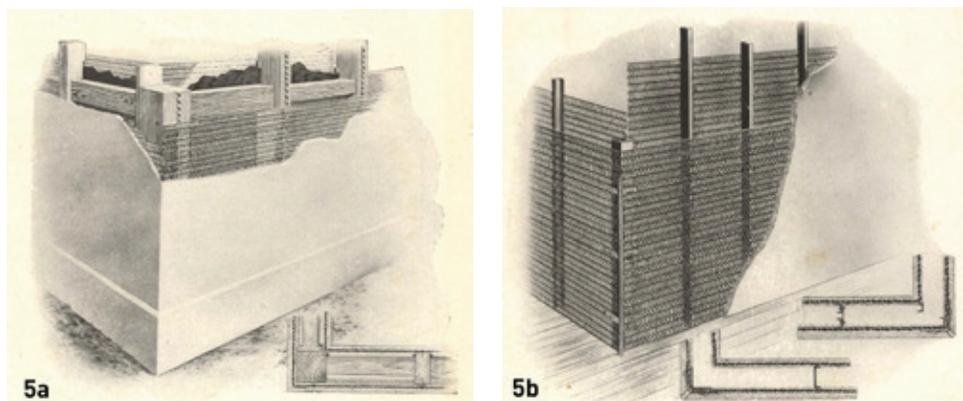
Detalles del empleo de la malla Herringbone en tabiques huecos (a dos caras) sobre estructuras de madera (5a) y metálicas (5b). Fuente: Herringbone houses: being a presentation of some of the advantages of cement construction for houses, together with mention of products of the General Fireproofing Company of Youngstown, Ohio, etc.
